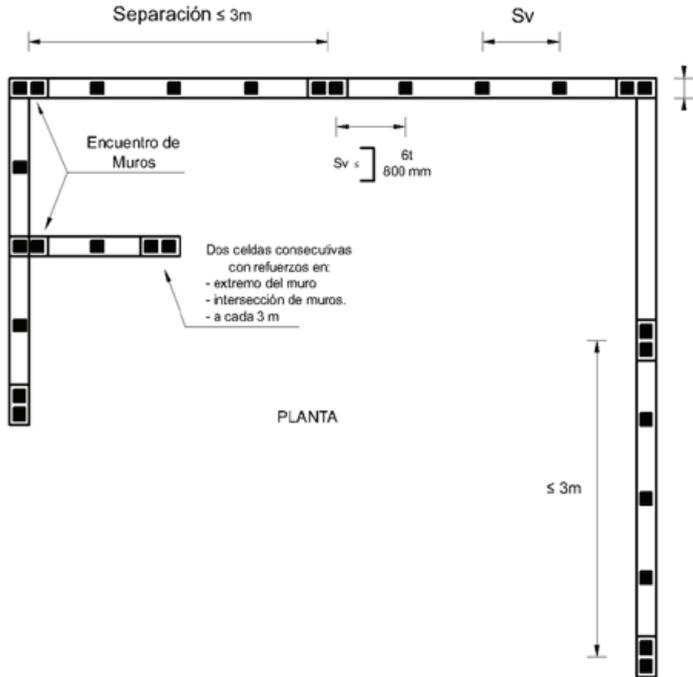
Planta típica de muros reforzados, ubicación del refuerzo vertical
